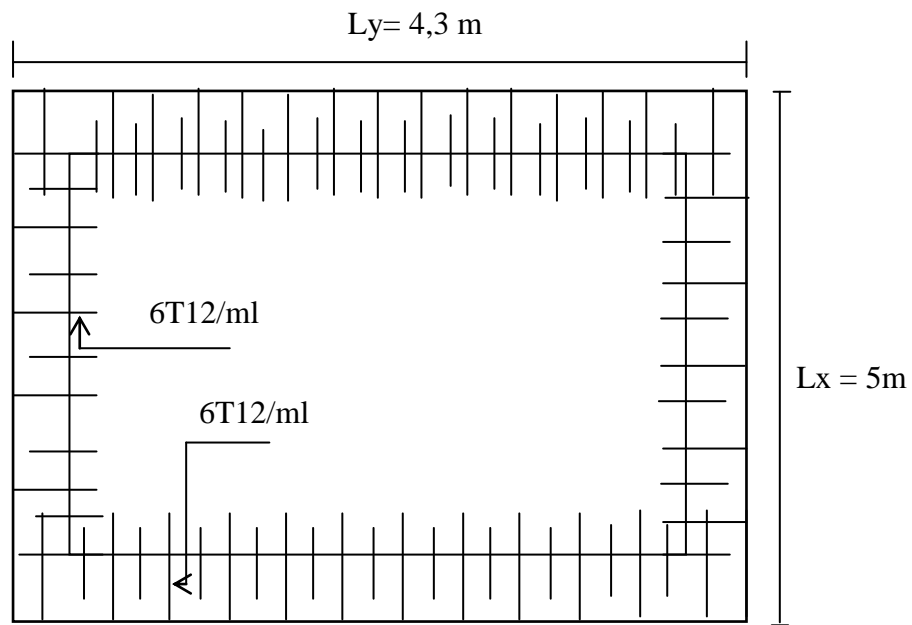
Schéma Ferrailage Supérieur du panneau de la dalle pleine.
